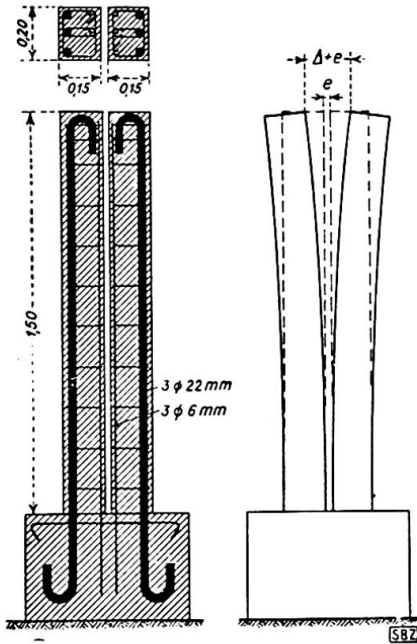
(ci-dessus). Dalle d'essai avant (a) et après (b) expansion du béton.
